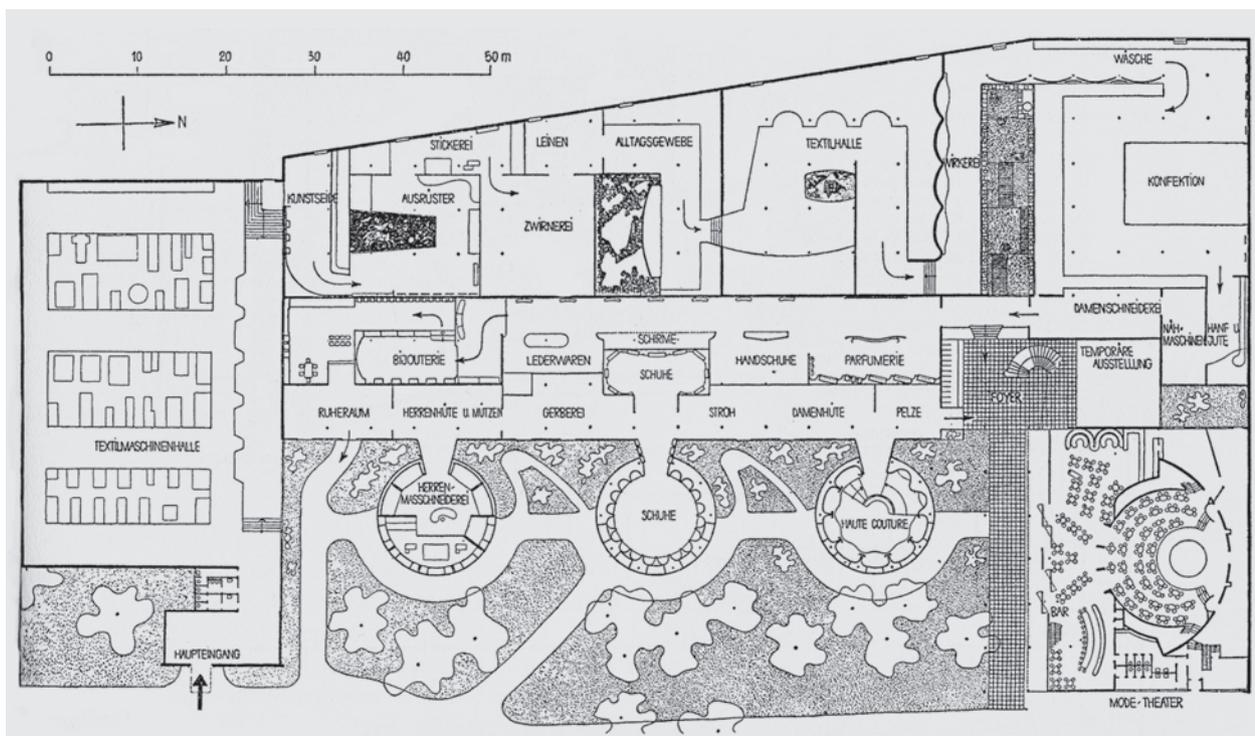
Grundriss Modepavillon, Architekt: Karl Egender.
